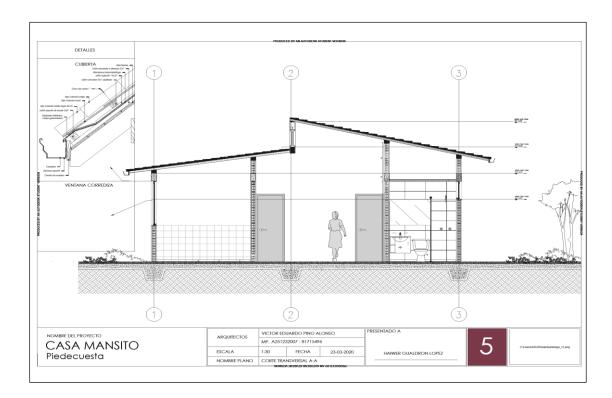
Plano Arquitectónico – Corte Transversal A-A – Proyecto Casa Mansito Fuente: Roble & Asociados
